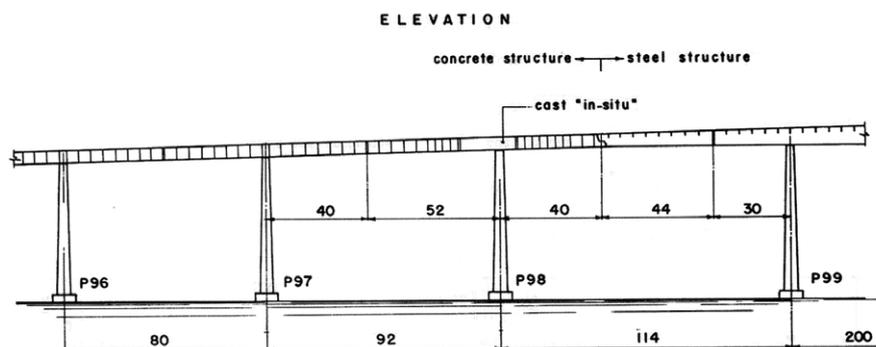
TRECHO DE 92M AO LADO DOS VÃOS PRINCIPAIS. O TRECHO DE 12M FOI CONSTRUÍDO IN SITU COM UM PILAR PROVISÓRIO AO LADO DO P98 PARA ATENDER AO PRAZO CONTRATUAL DE MONTAGEM DOS VÃOS CENTRAIS DE AÇO
